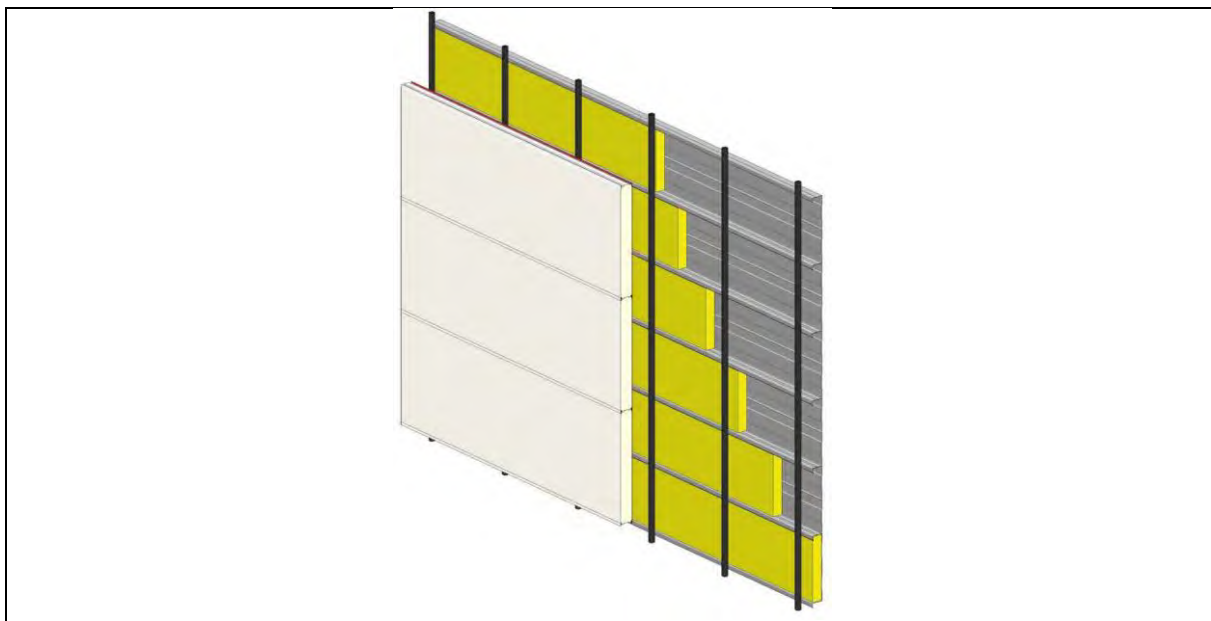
„Hybridisierung“ einer Kassettenprofilfassade mit horizontal verlegten Sandwichelementen
